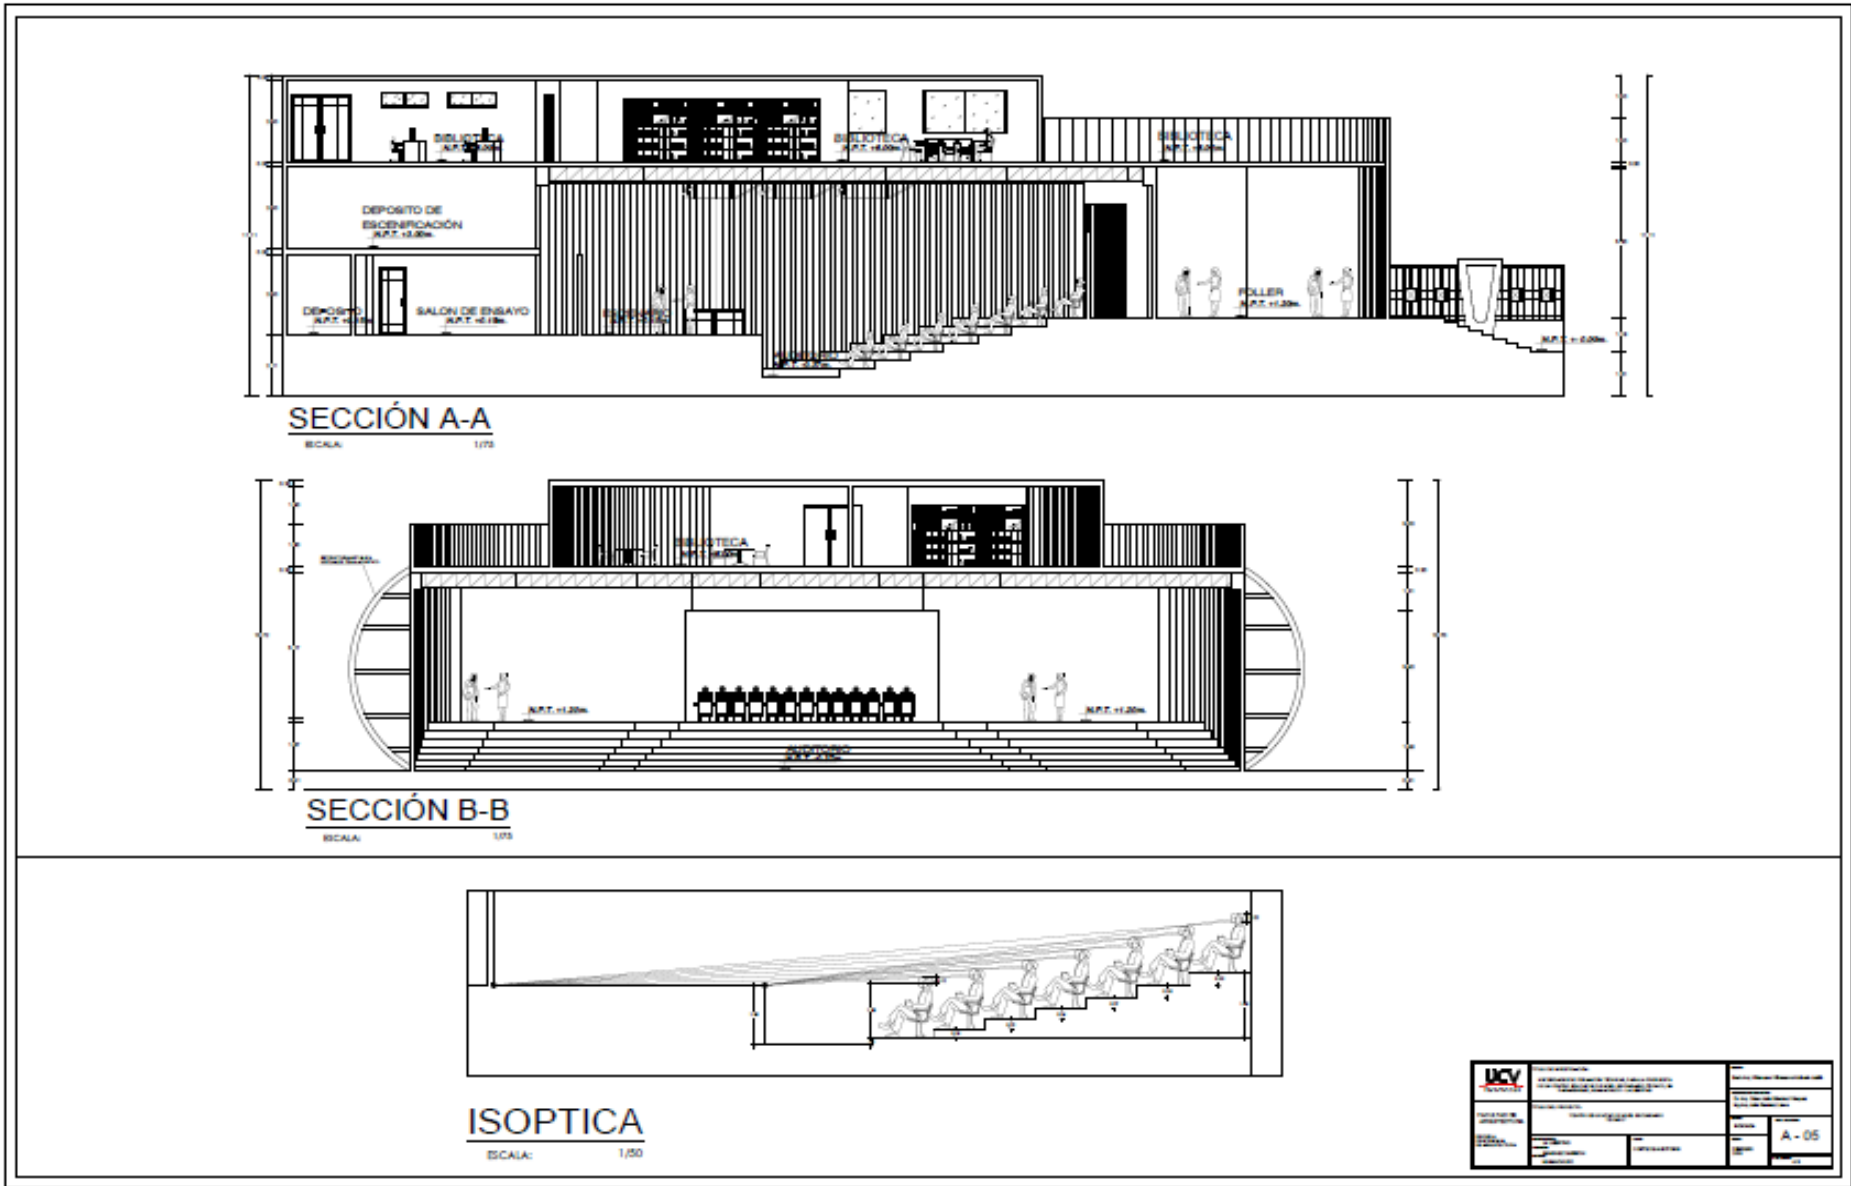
Plano de Detalles Arquitectonicos y/o Constructivos Especificos –Detalle Auditorio- Plano N° 36 - Lamina A-05
